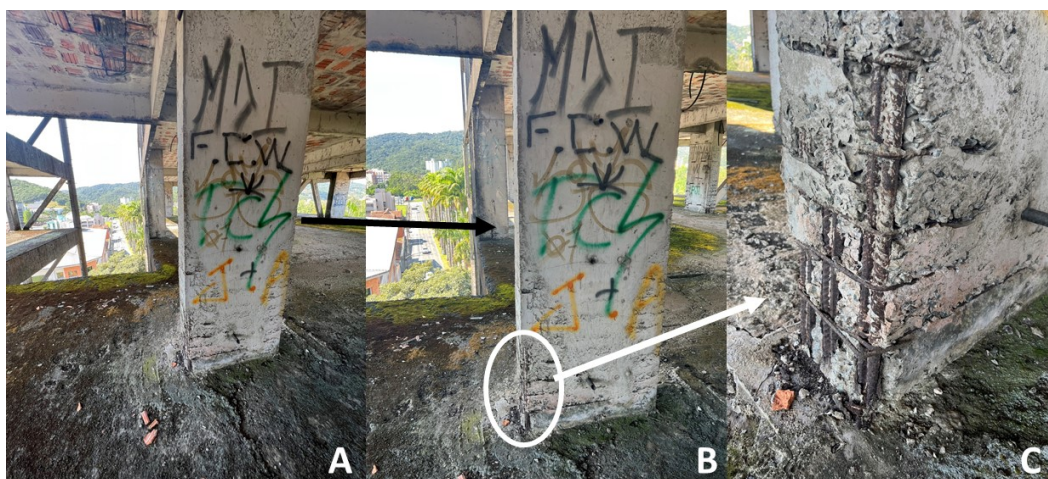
Pilar P49: (A e B) localização; (C) pormenor.
